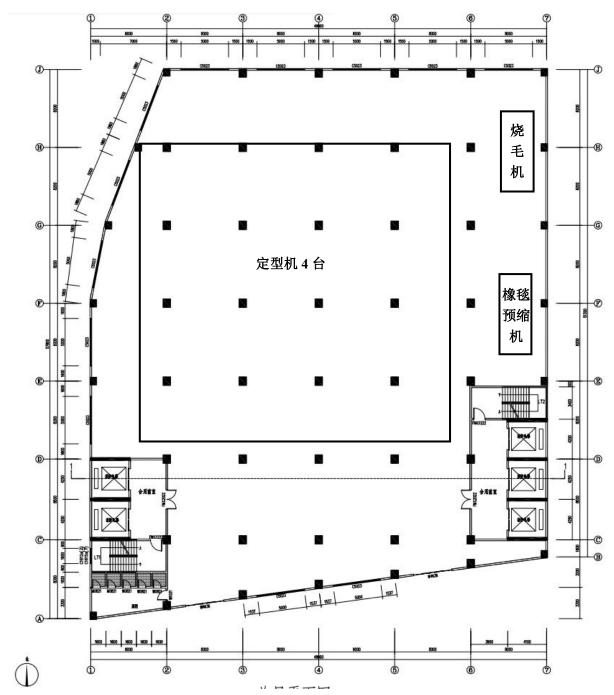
原有项目 (B 栋厂房) 2 楼平面布置图
